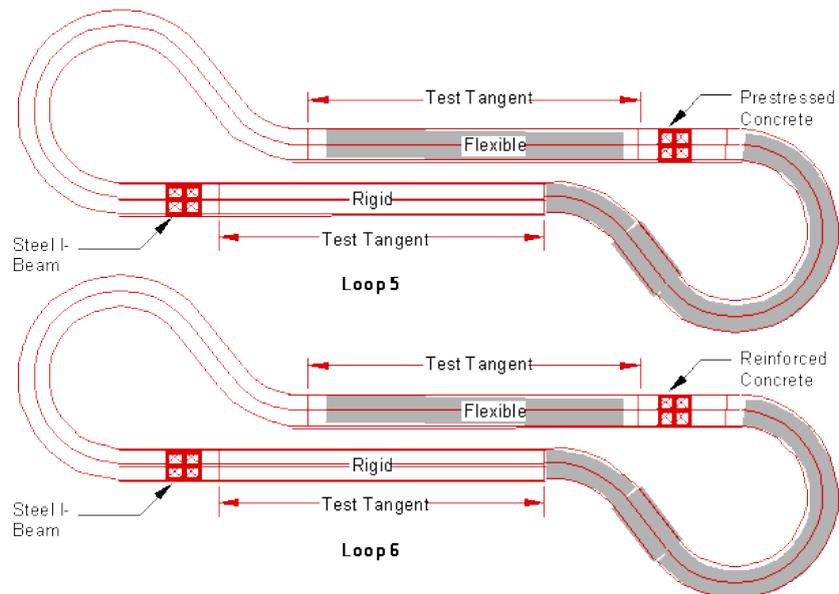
Layout da pista experimental da AASHO (redesenhada pelo HRB em 1961).
